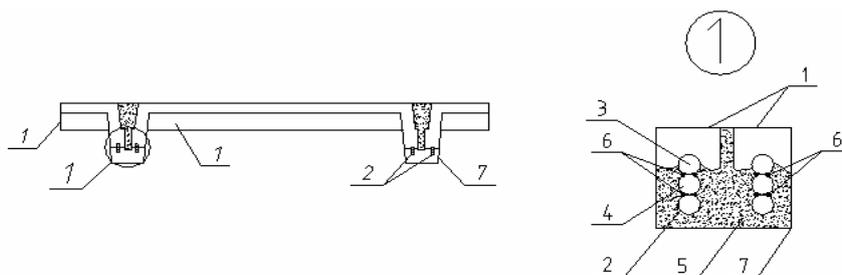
Усиление ребристых плит установкой дополнительных рабочих арматуры в растянутой зоне: 1 – усиливаемые плиты; 2 – дополнительные плиты; 3 – дополнительная арматура; 4 – арматура плит, оголенная на участке длиной 100 мм через 1,0 м по длине; 5 – бетон или раствор; 6 – сварка; 7 – антикоррозийное лакокрасочное покрытие
